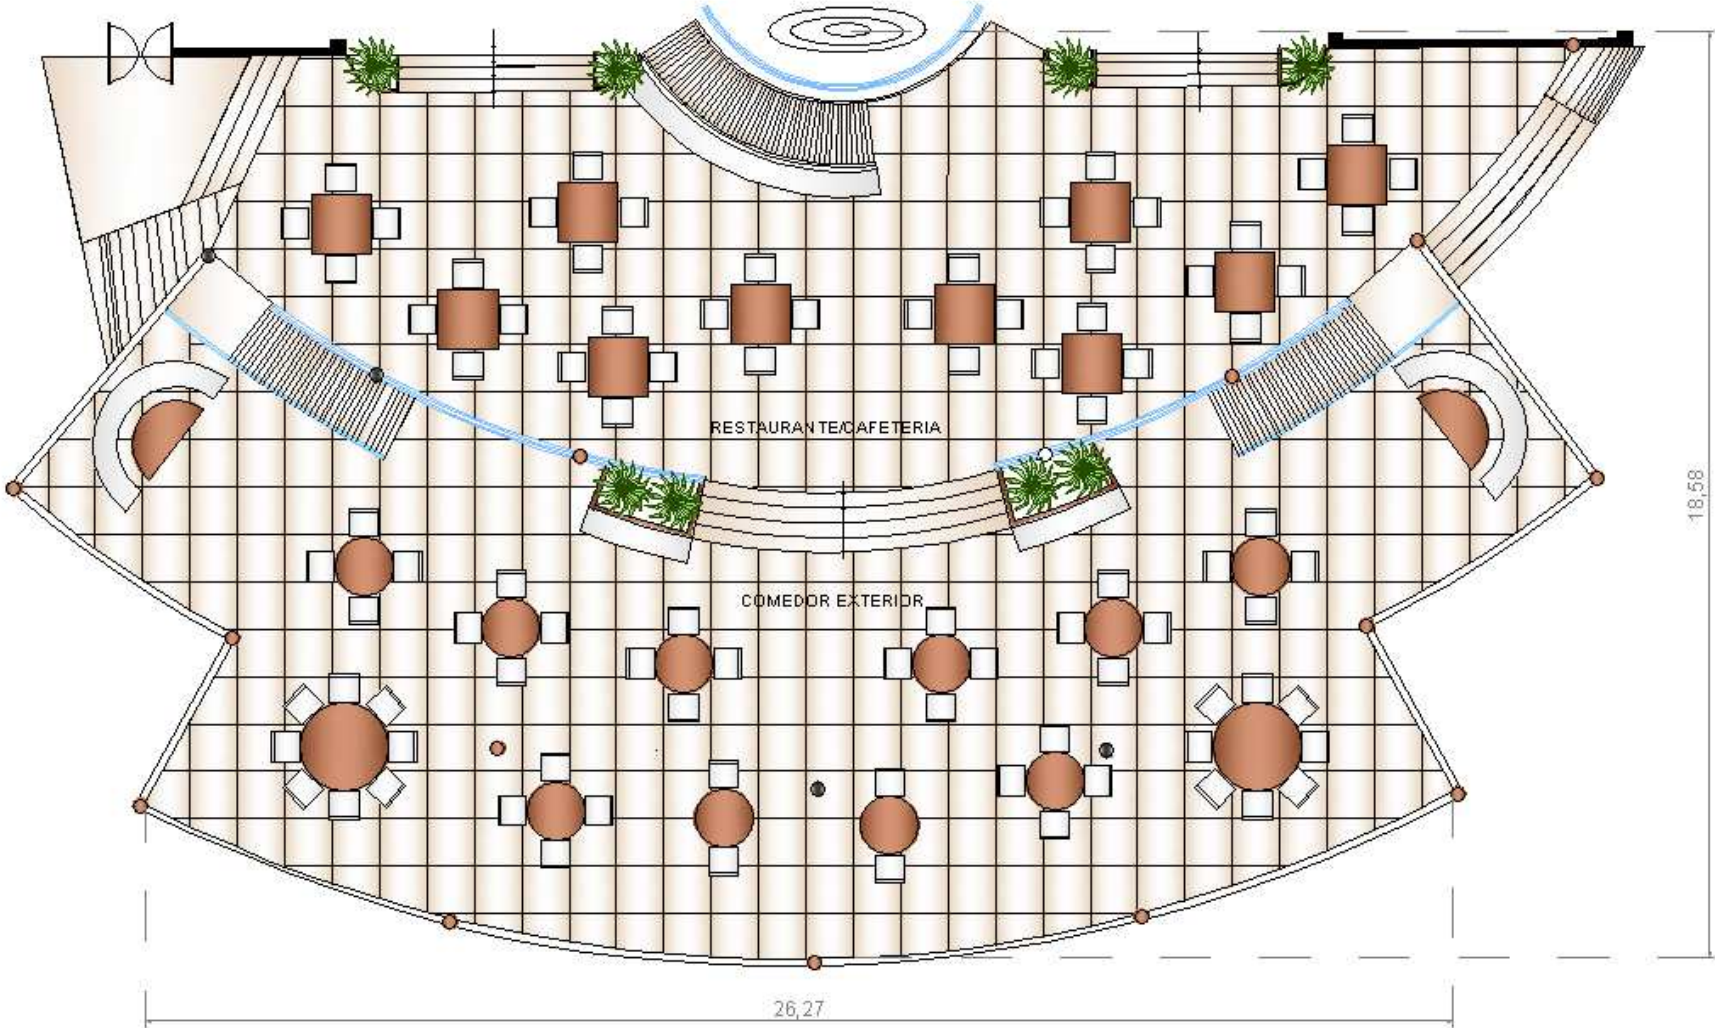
Plano dimensionado: Restaurante-Cafetería y Comedor Exterior
